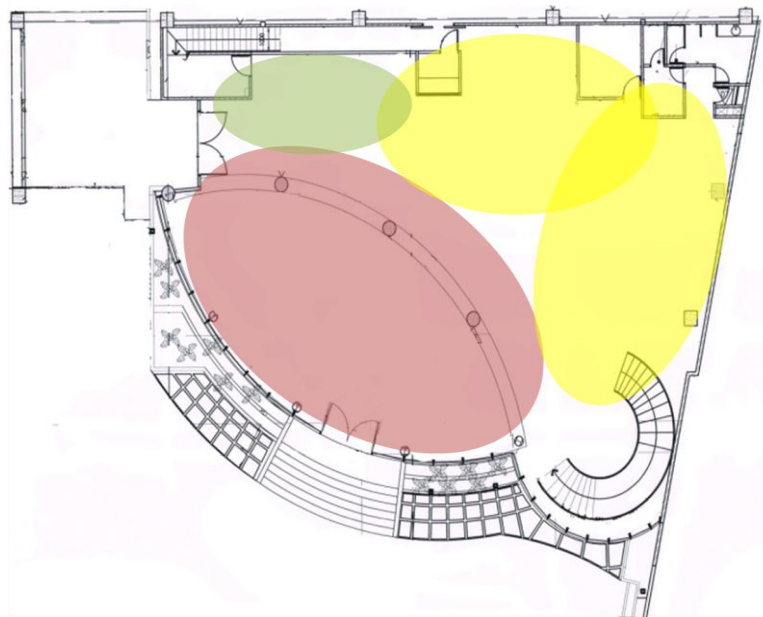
Zoning dan Grouping Alternatif 2 Lantai 1
